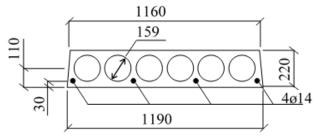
Сечение и размеры сечения пустотной плиты
